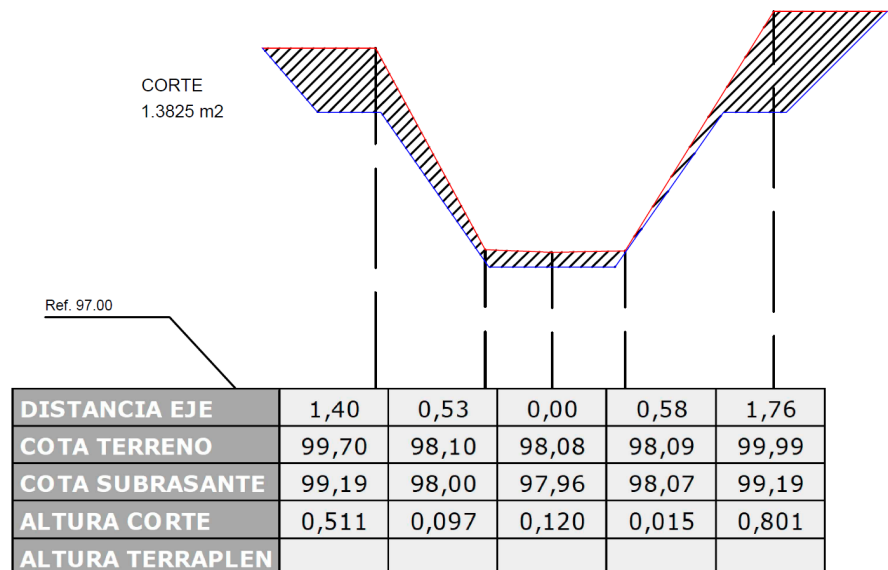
Perfil Transversal N°3 (Fuente Propia)
